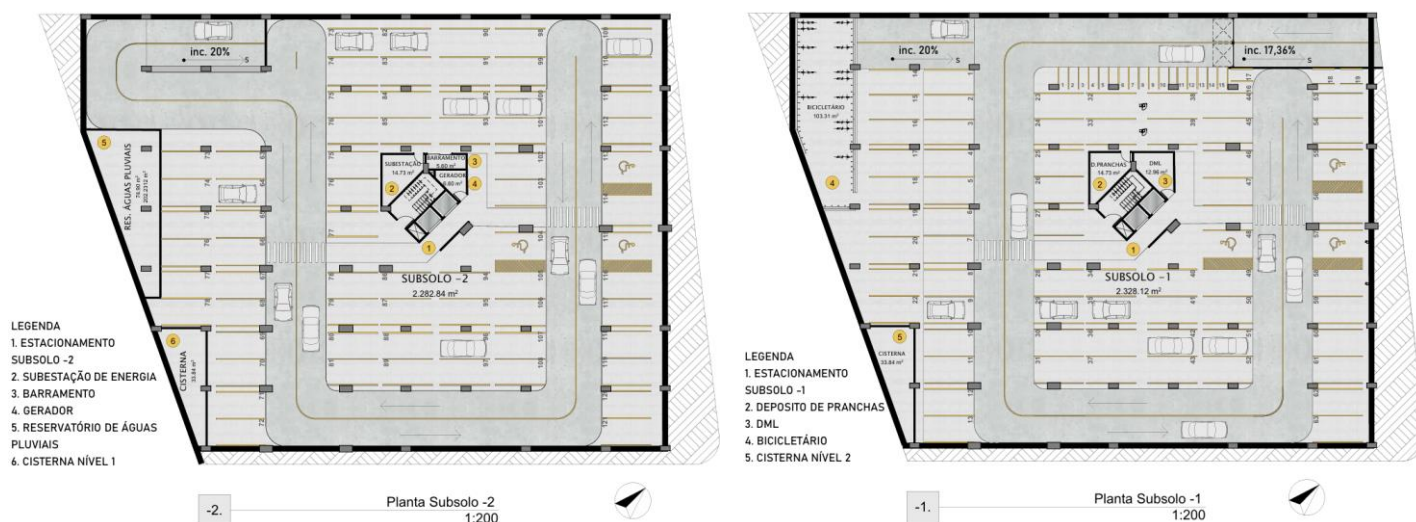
Plantas humanizadas: Garagens subsolo. Escala reduzido. (a) Subsolo -2 (b) Subsolo -1.
